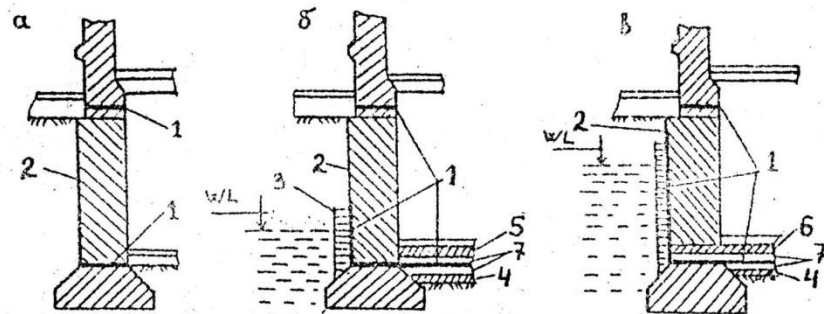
Гидроизоляция подвальных помещений: а – при уровне подземных вод ниже пола подвала; б – при уровне подземных вод выше пола подвала; в – в то же, при высоком стоянии; 1 – рулонная гидроизоляция; 2 – обмазка битумом за два раза; 3 – прижимная стенка; 4 – бетонная подготовка; 5 – пригрузочный бетон; 6 – железобетонная плита; 7 – цементная стяжка.
